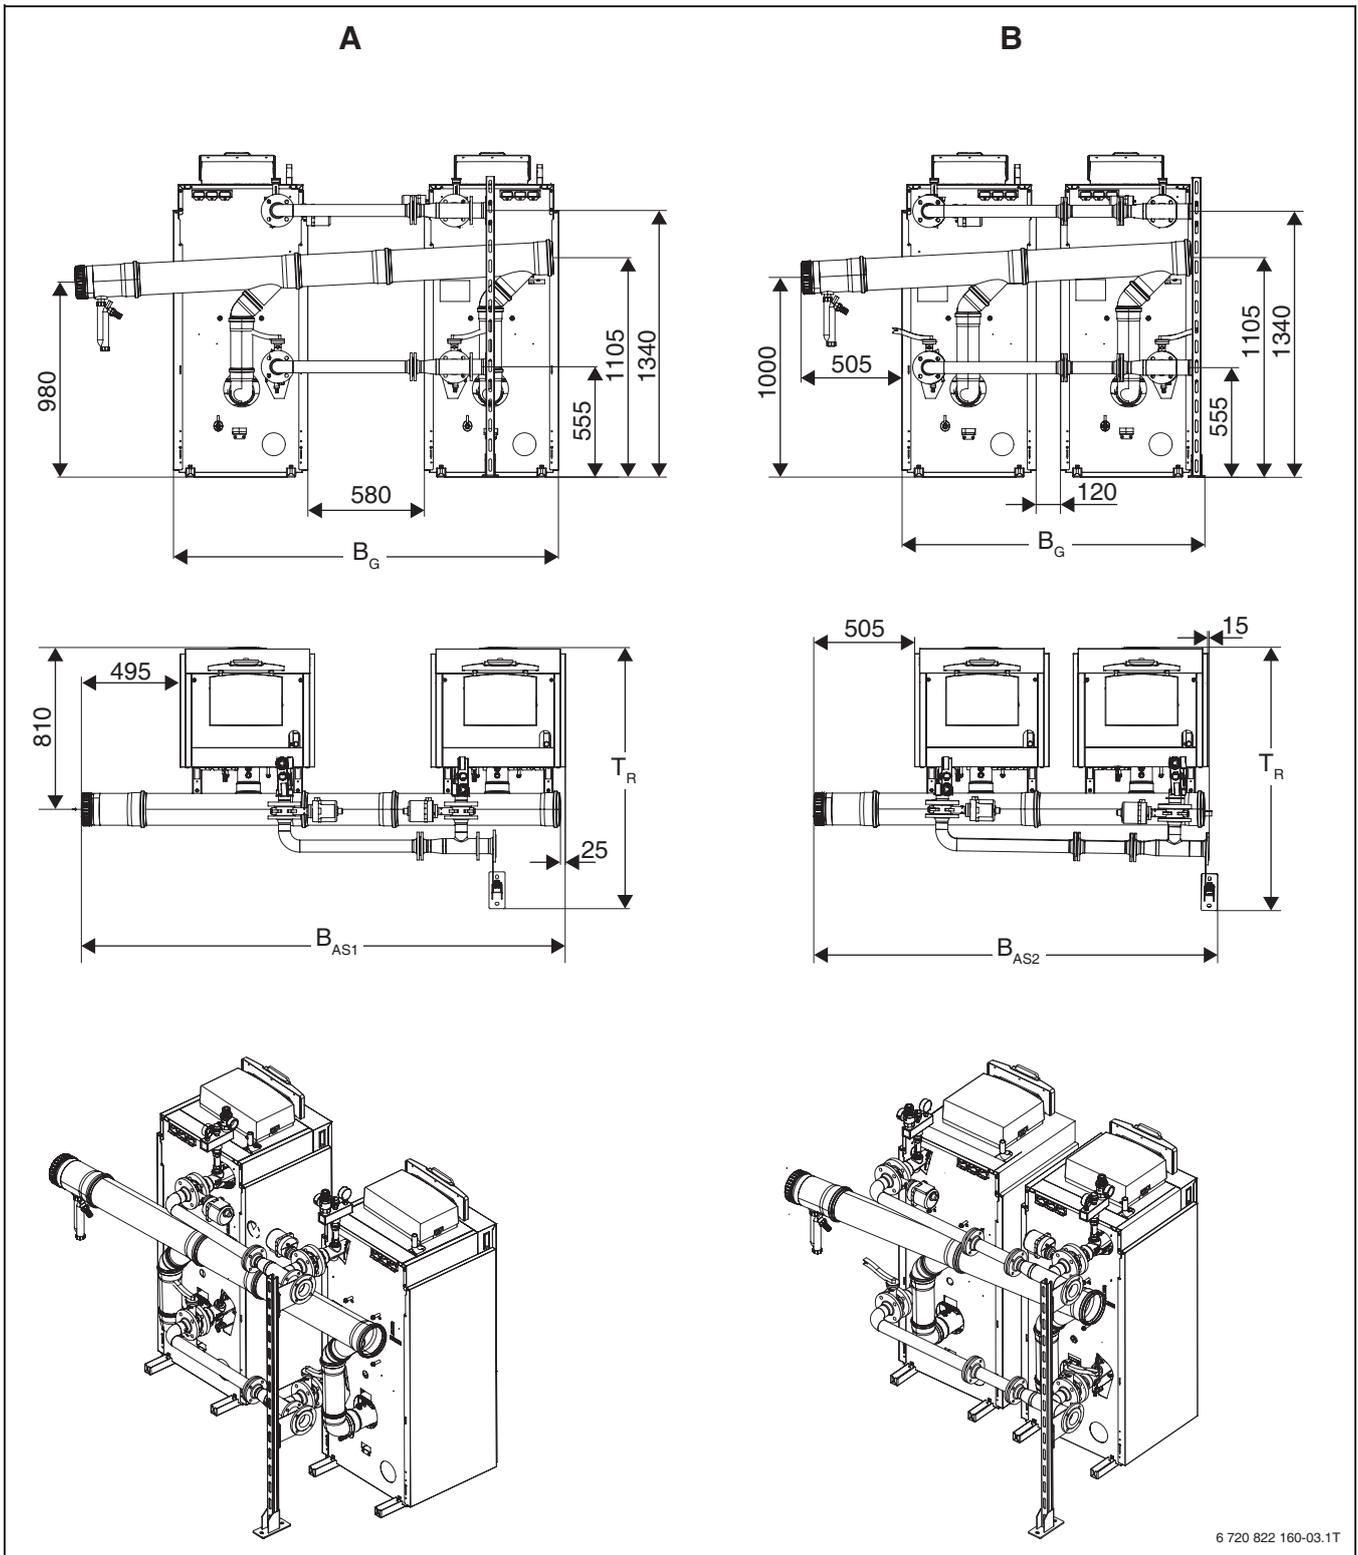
Abmessungen GC7000F, 2 × 75 und 2 × 100 kW – werkseitige 2-Kessel-Kaskade mit motor-gesteuerter hydraulischer Absperrklappe; (Maße in mm)
